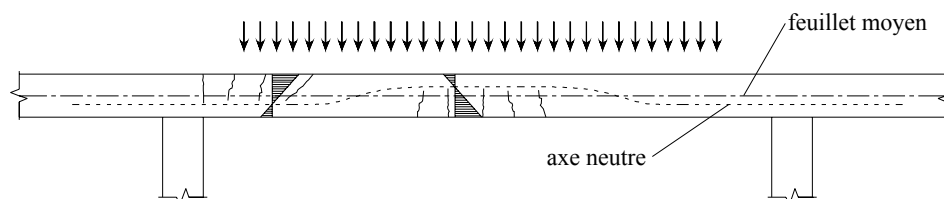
Allongement du feuillet moyen de la dalle causé par la fissuration (dilatance)
